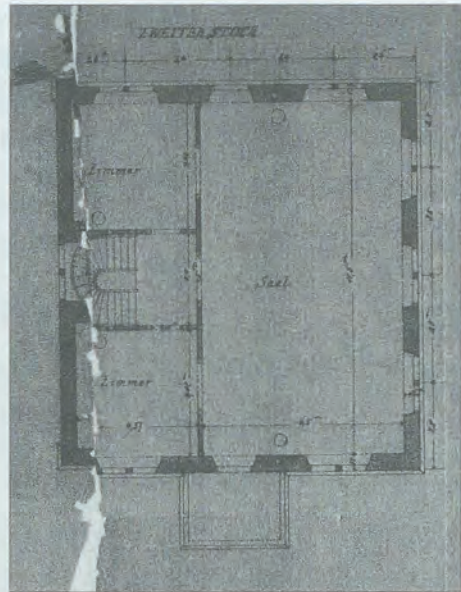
Plan III, Grundriss zweites Stockwerk. Generallandesarchiv Karlsruhe, Az.: 377/15231
